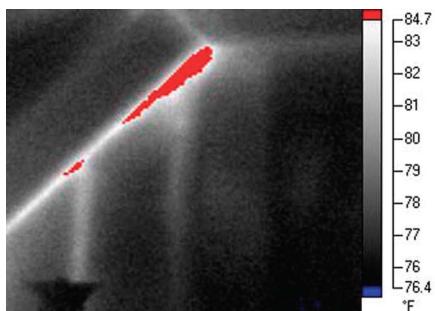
Красный цвет насыщения цветовой палитры четко указывает плохую укладку теплоизоляции из стекловолокна в наклонной кровле.
